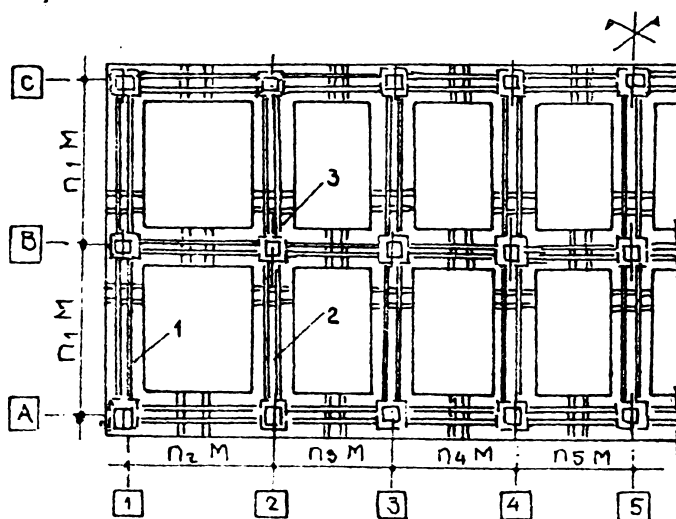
Alcătuirea tăpii fundației din elemente prefabricate: 1-element L; 2-element P; 3- element X.
